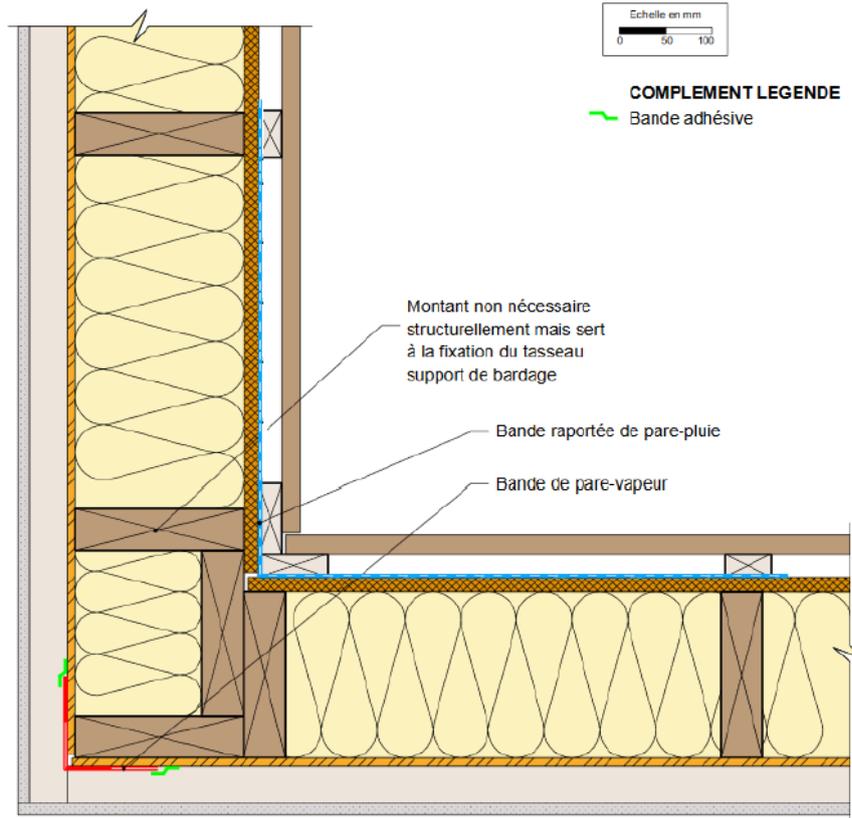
Exemple d'un angle rentrant (coupe horizontale)
